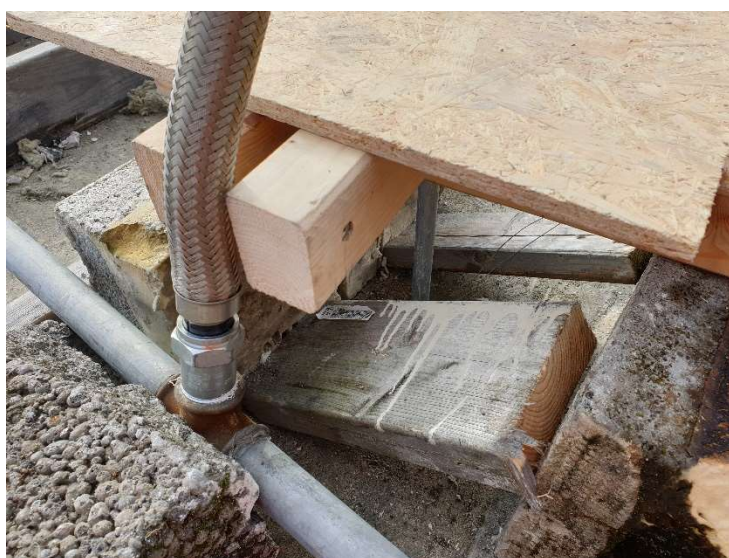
Sprinklerhodet på enden av to bender med 90° vinkling hver.
